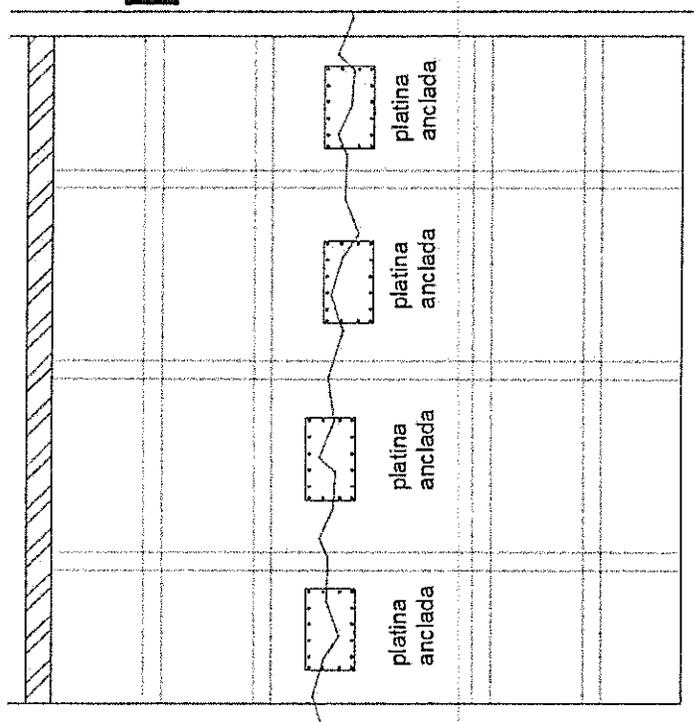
Armazón metálico de refuerzo. "fuente propia"
